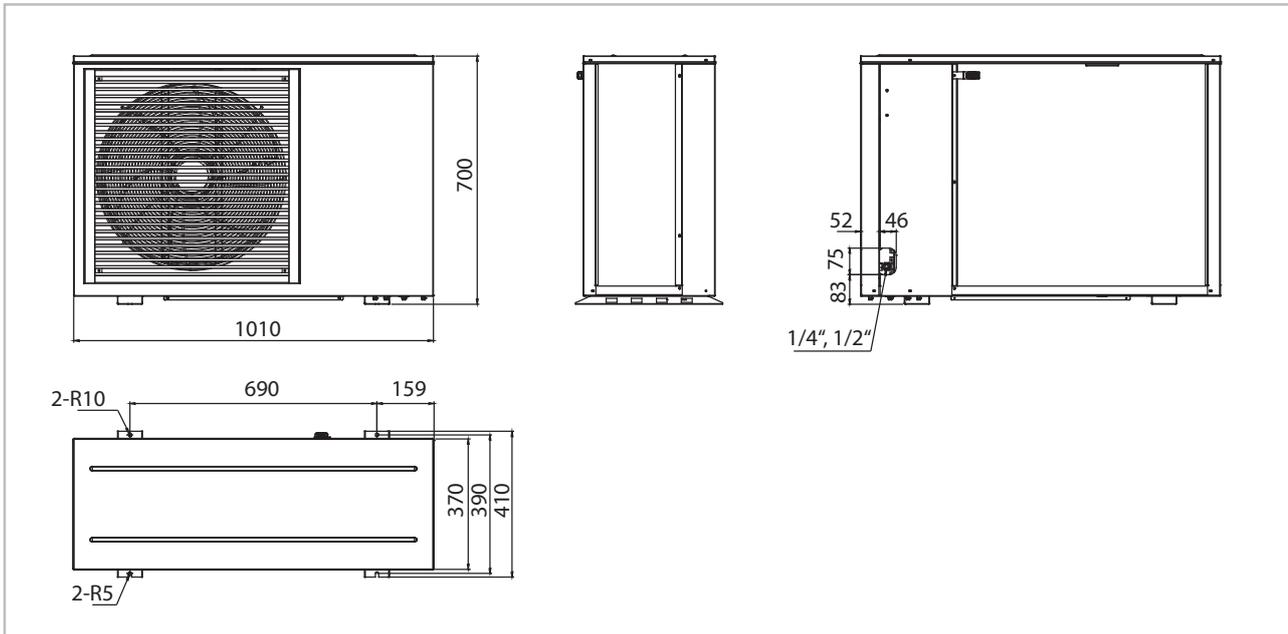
Dimensions des modules externes WKF NEO-compact 80
